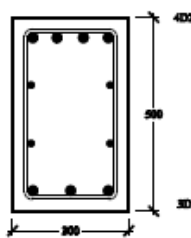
Penulangan Kolom *Precast* (Sumber: *Shop Drawing* Departemen Pekerjaan Umum)
